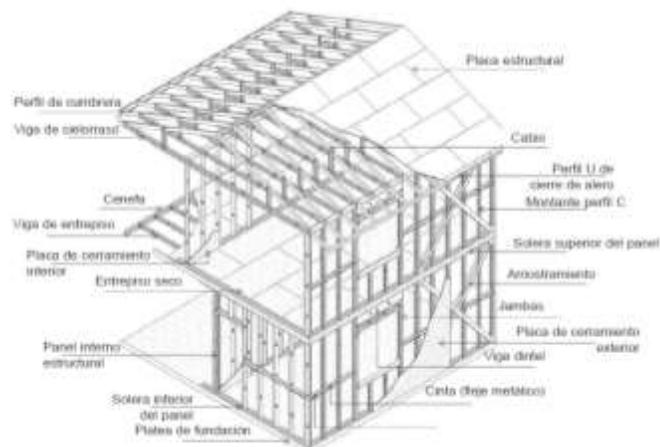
Vista esquemática de una vivienda en Steel Framing.
